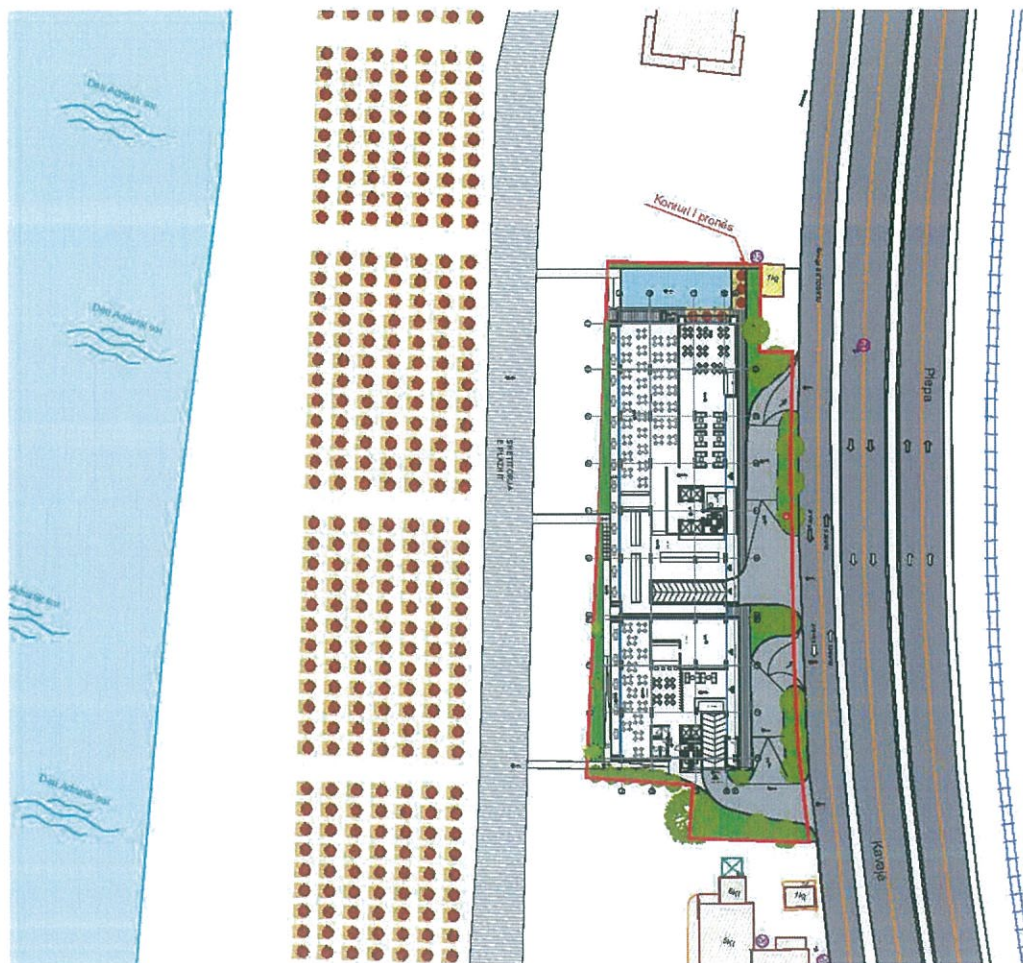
Plani i hapësirave të jashtme të objektit të propozuar
